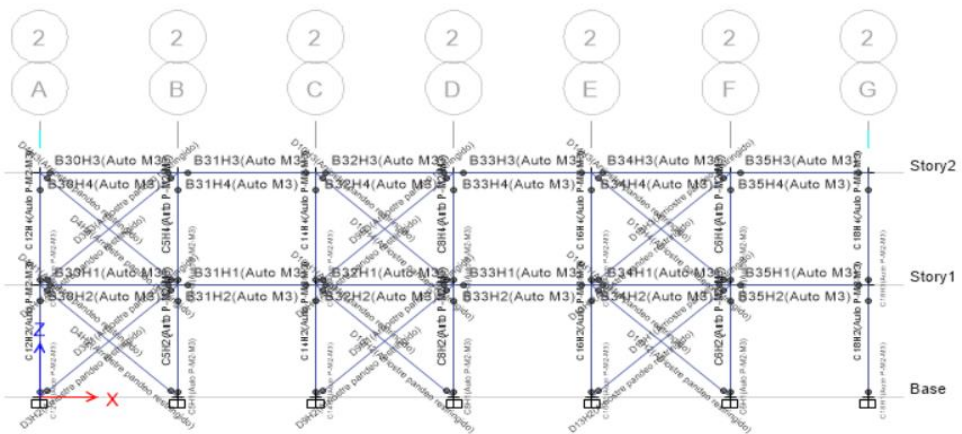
Vista en ZX de la estructura de acero con las rótulas plásticas.
